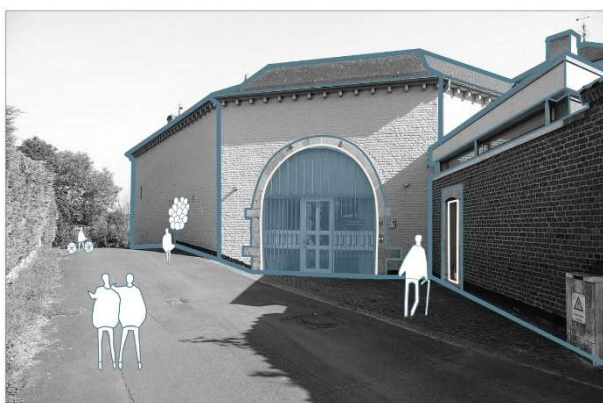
Collage illustrant l'entrée principale de la maison (façade Nord-Ouest)
